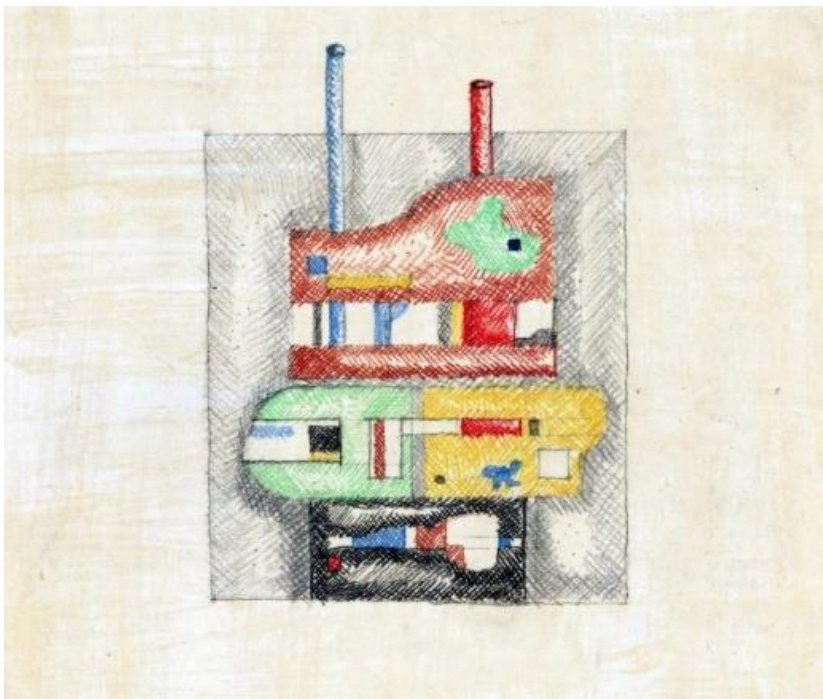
ภาพวาดบ้าน Wall House 2 (A.B. Bye House) โดย John Hejduk (1973-76)
